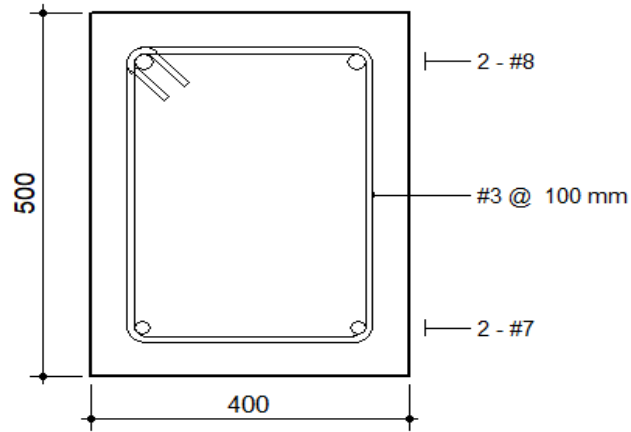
Sección de viga interior plantas 5 y 6. Fuente: Propia.
